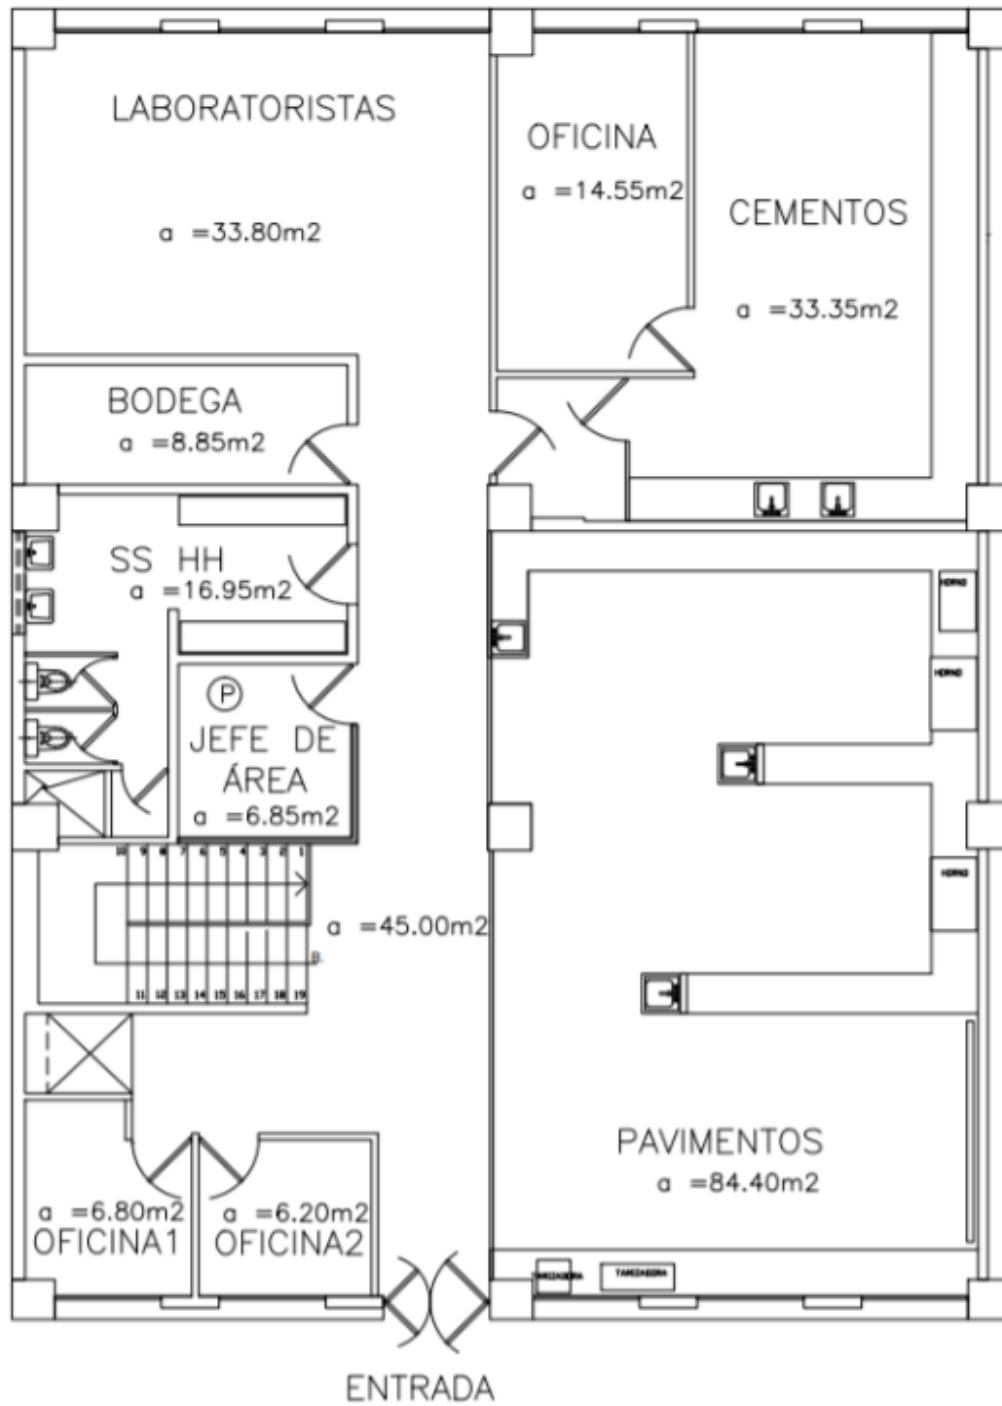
Plano General / Planta Alta Edificio Antiguo Laboratorio de Ingeniería
